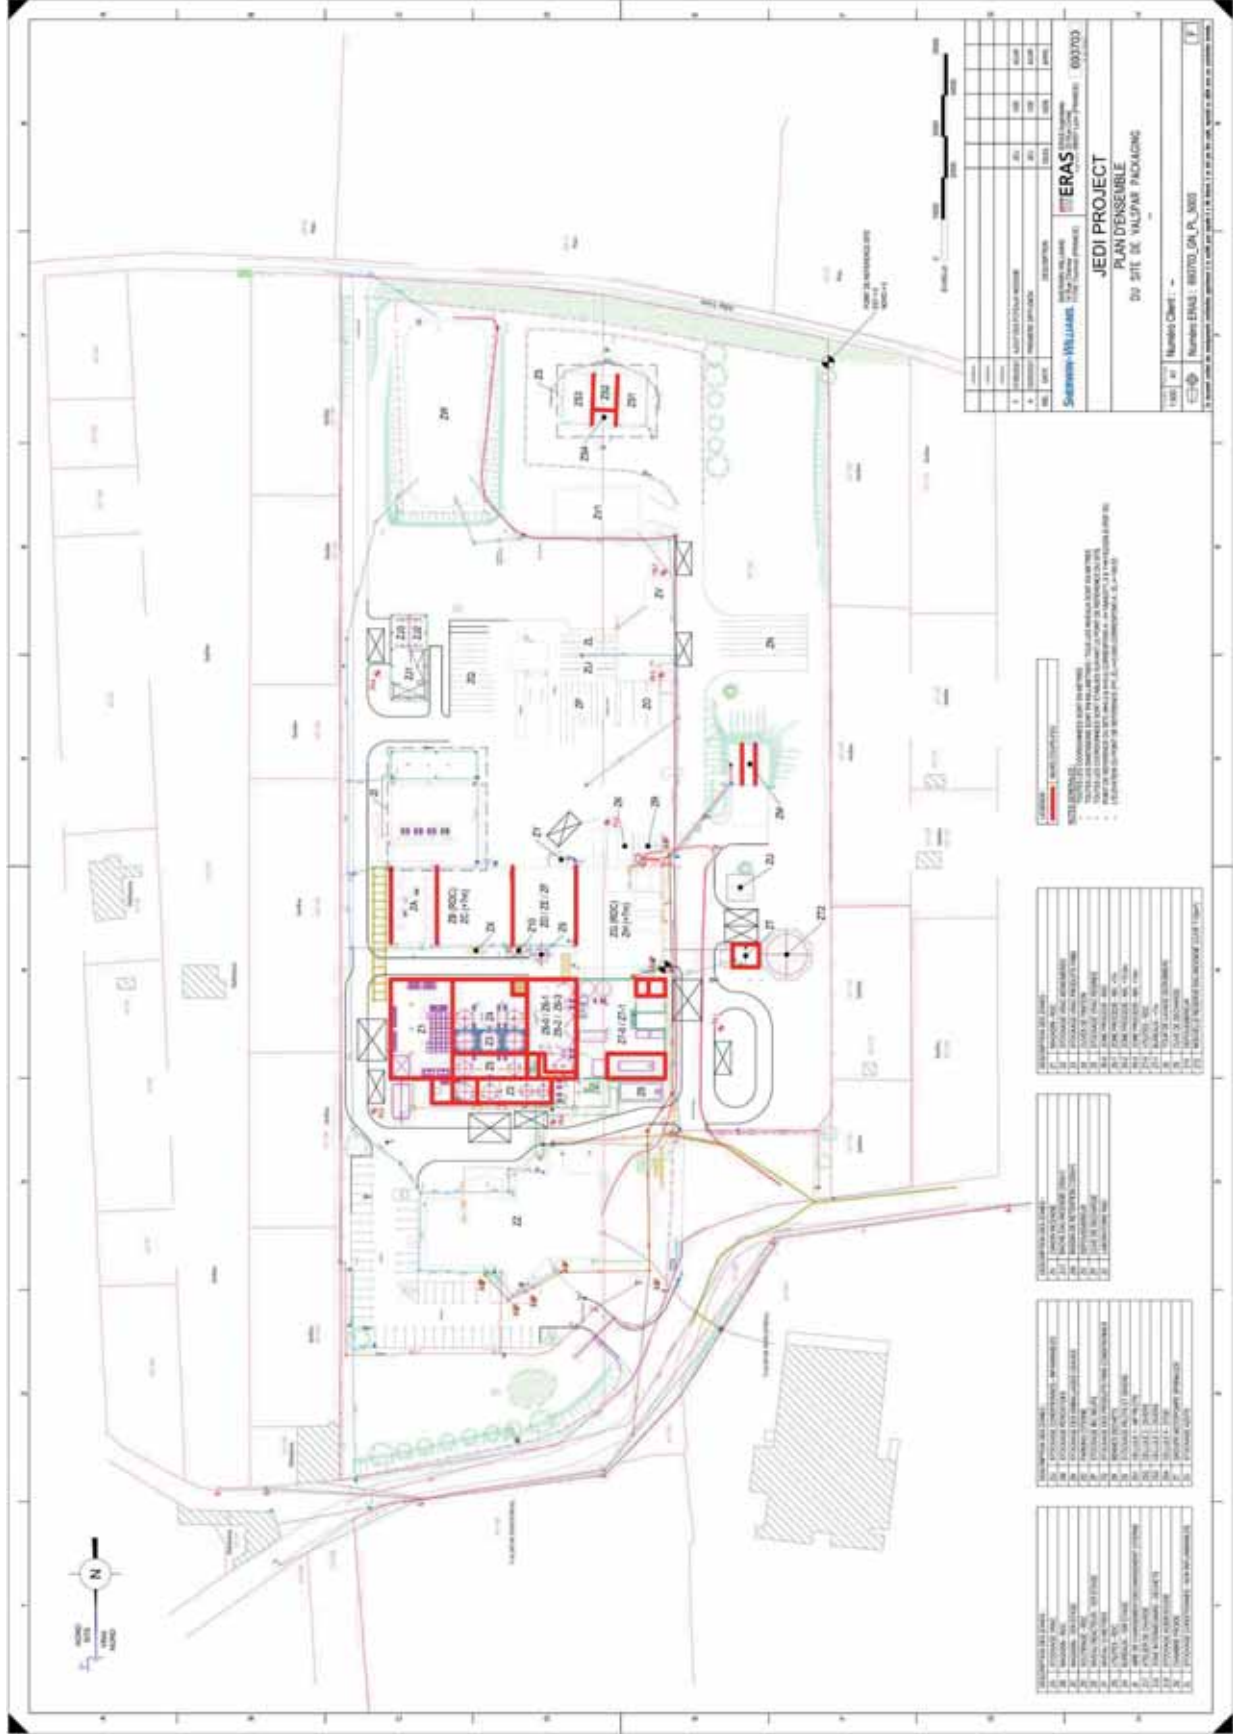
Plan de masse du projet – Plan d'ensemble (Source : envoi Client du 09/06/2021)
